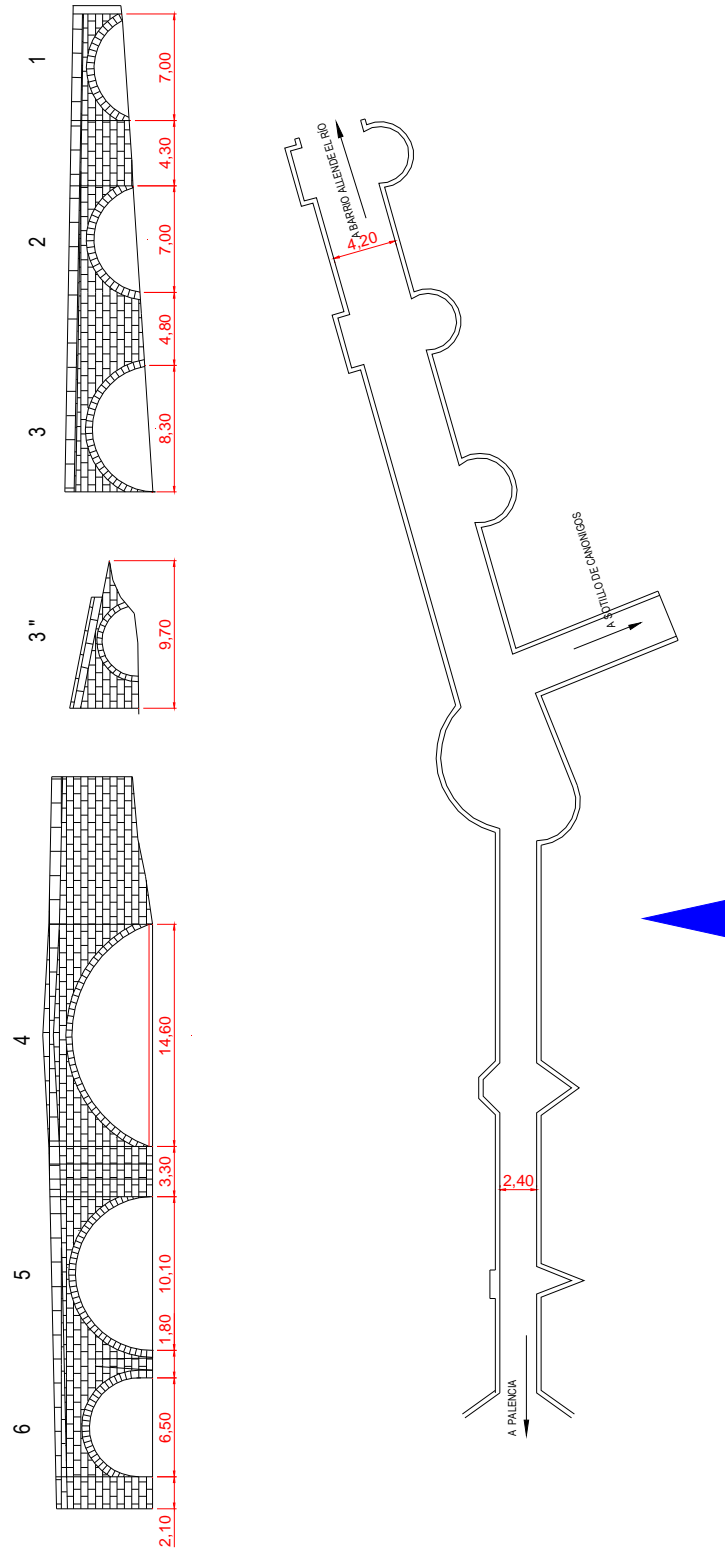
Planta y alzado de aguas arriba del puente de Puenteillas
